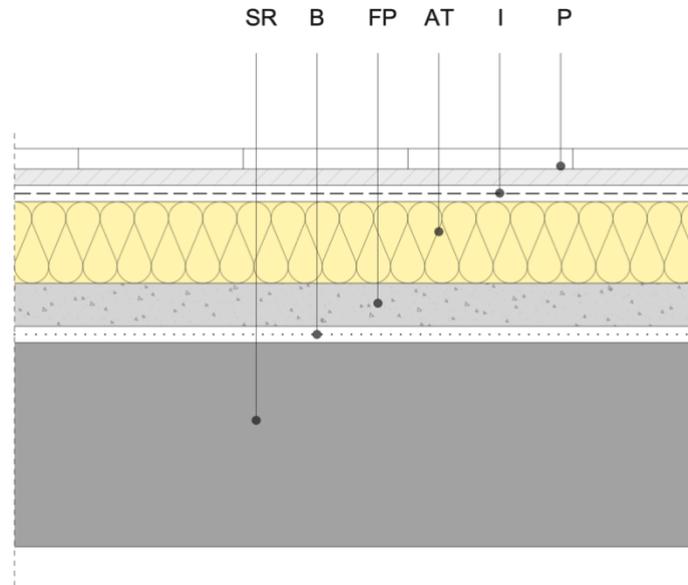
Cubierta no ventilada. Leyenda: SR Soporte resistente. B Barrera cortavapor. FP Formación de pendiente. AT Aislante térmico. I Impermeabilización. P Protección.
